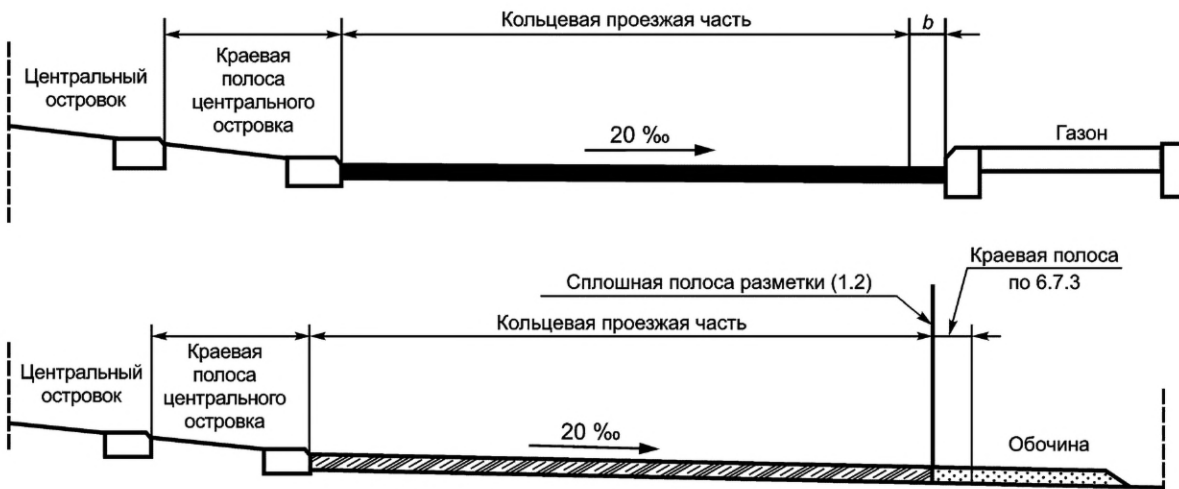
Типовой поперечный профиль кольцевого пересечения без пониженной части центрального островка
